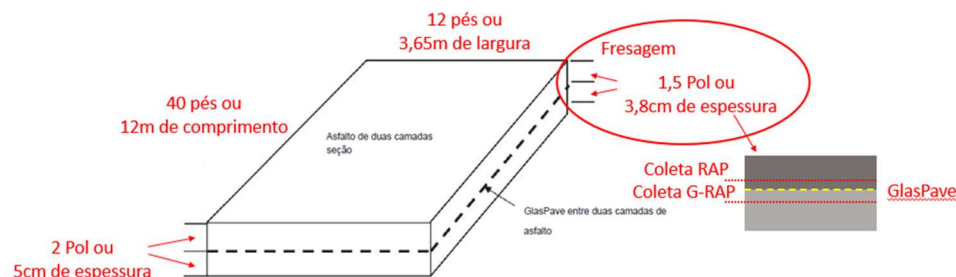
Detalhes das dimensões e espessura de fresagem da seção teste.
